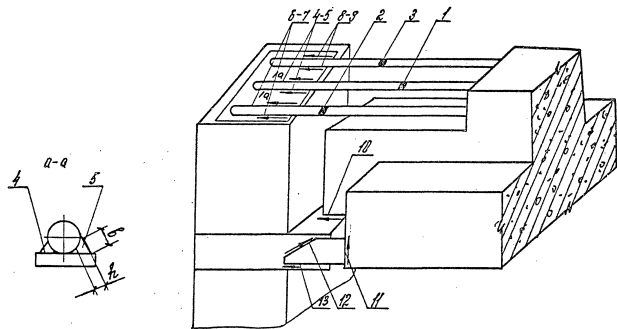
Порядок выполнения сварных соединений в узле сопряжения ригеля с колонной.
